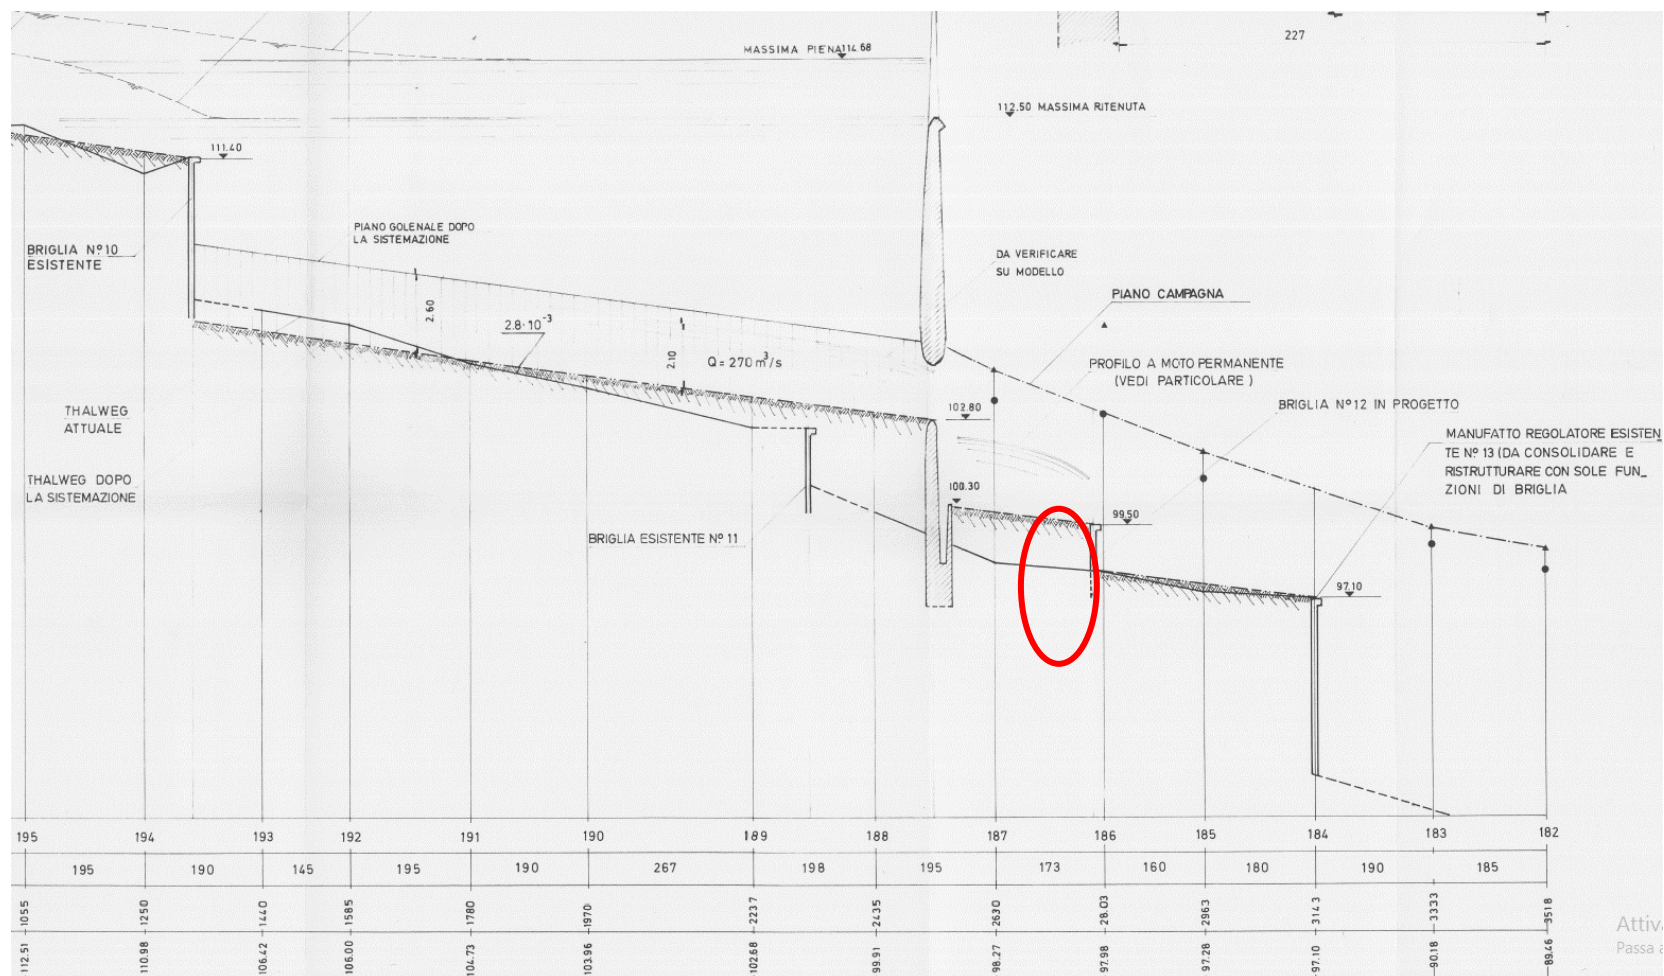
Profilo longitudinale del T. Crostolo (Allegato 18). La briglia n. 12 (di progetto 1983) è a circa 250m dalla diga
